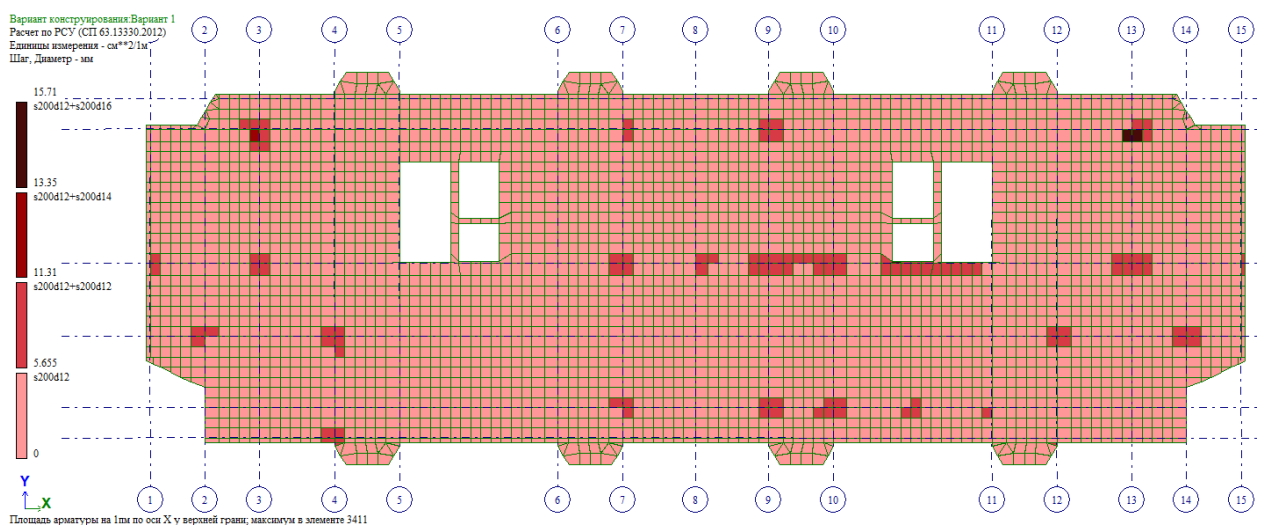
Подбор верхней продольной арматуры плиты по оси X
